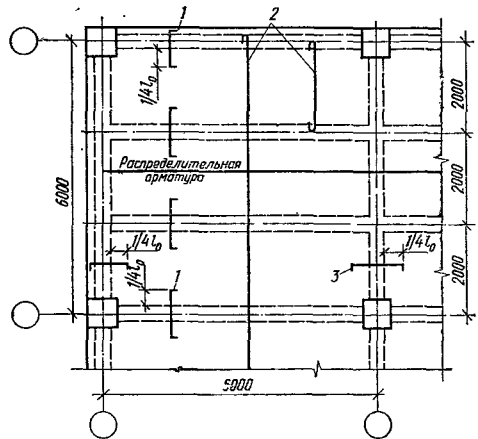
Раздельное армирование монолитных балочных плит отдельными стержнями (вязаной арматурой):
